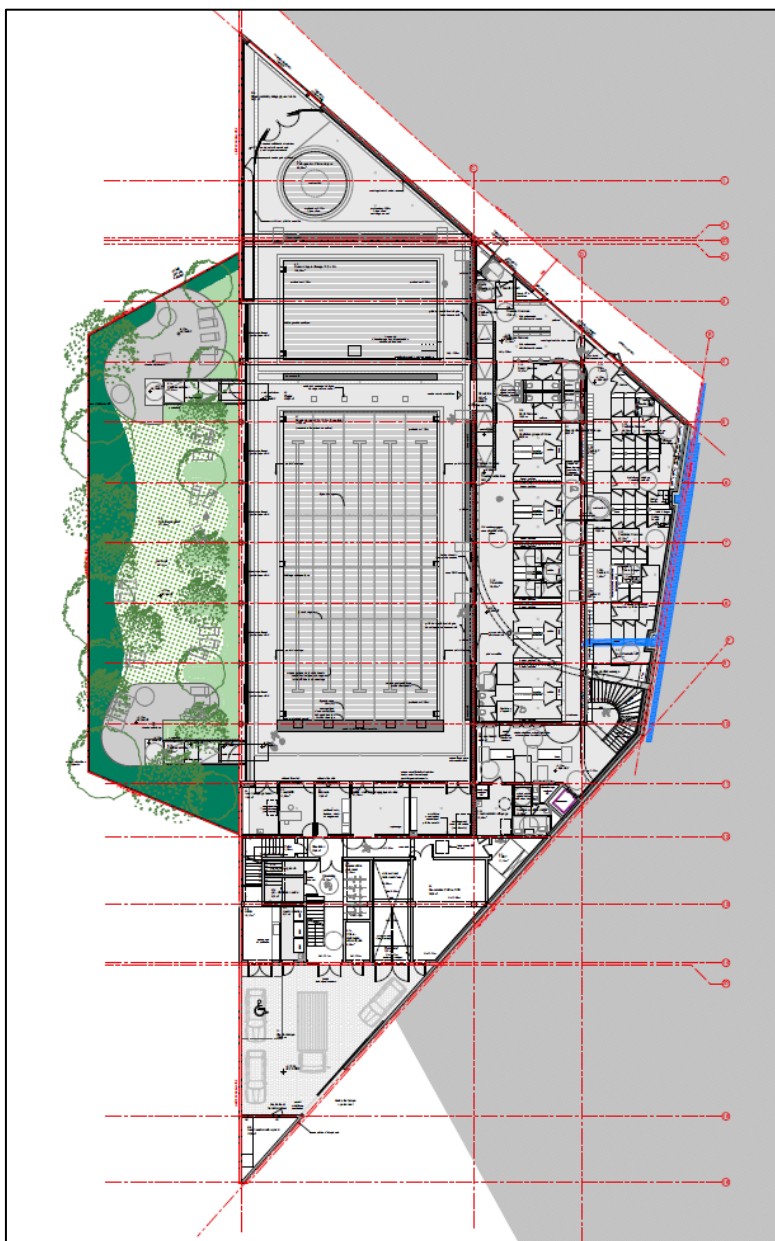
Extrait plan RDJ jardin parc plan 2104 PRO provisoire
